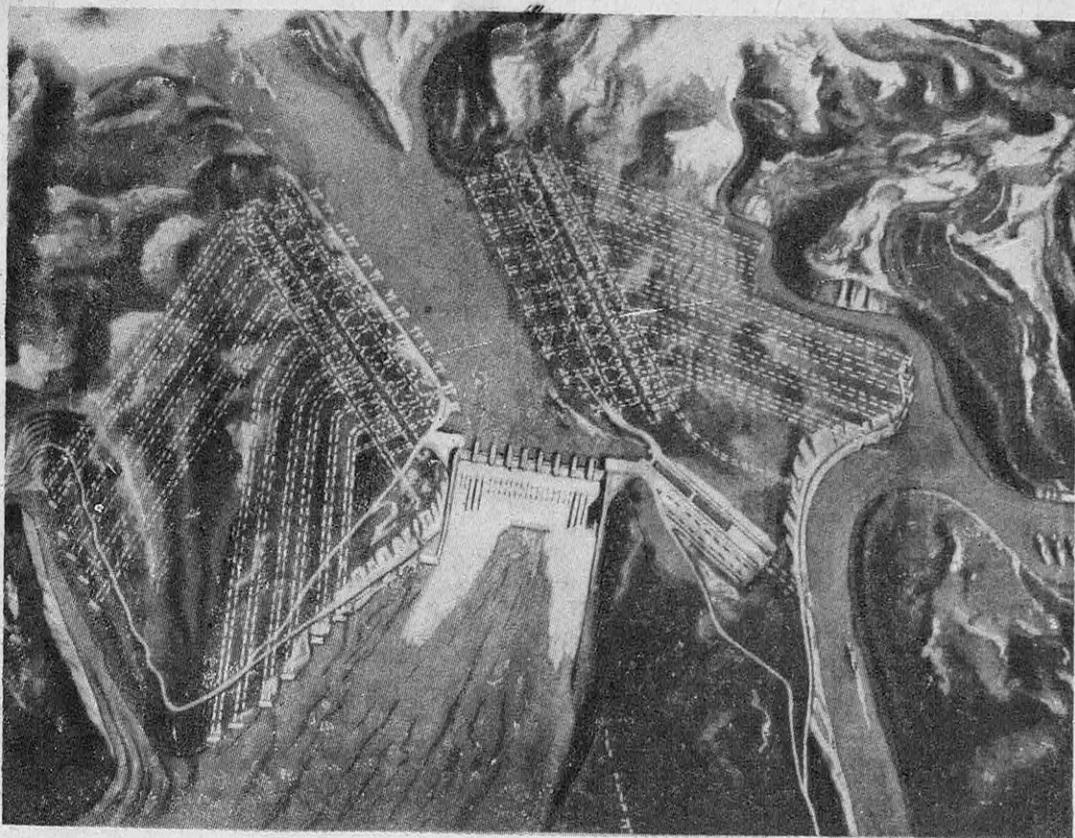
DISPOSITION GÉNÉRALE DU BARRAGE SUR LE YANGTSÉ
